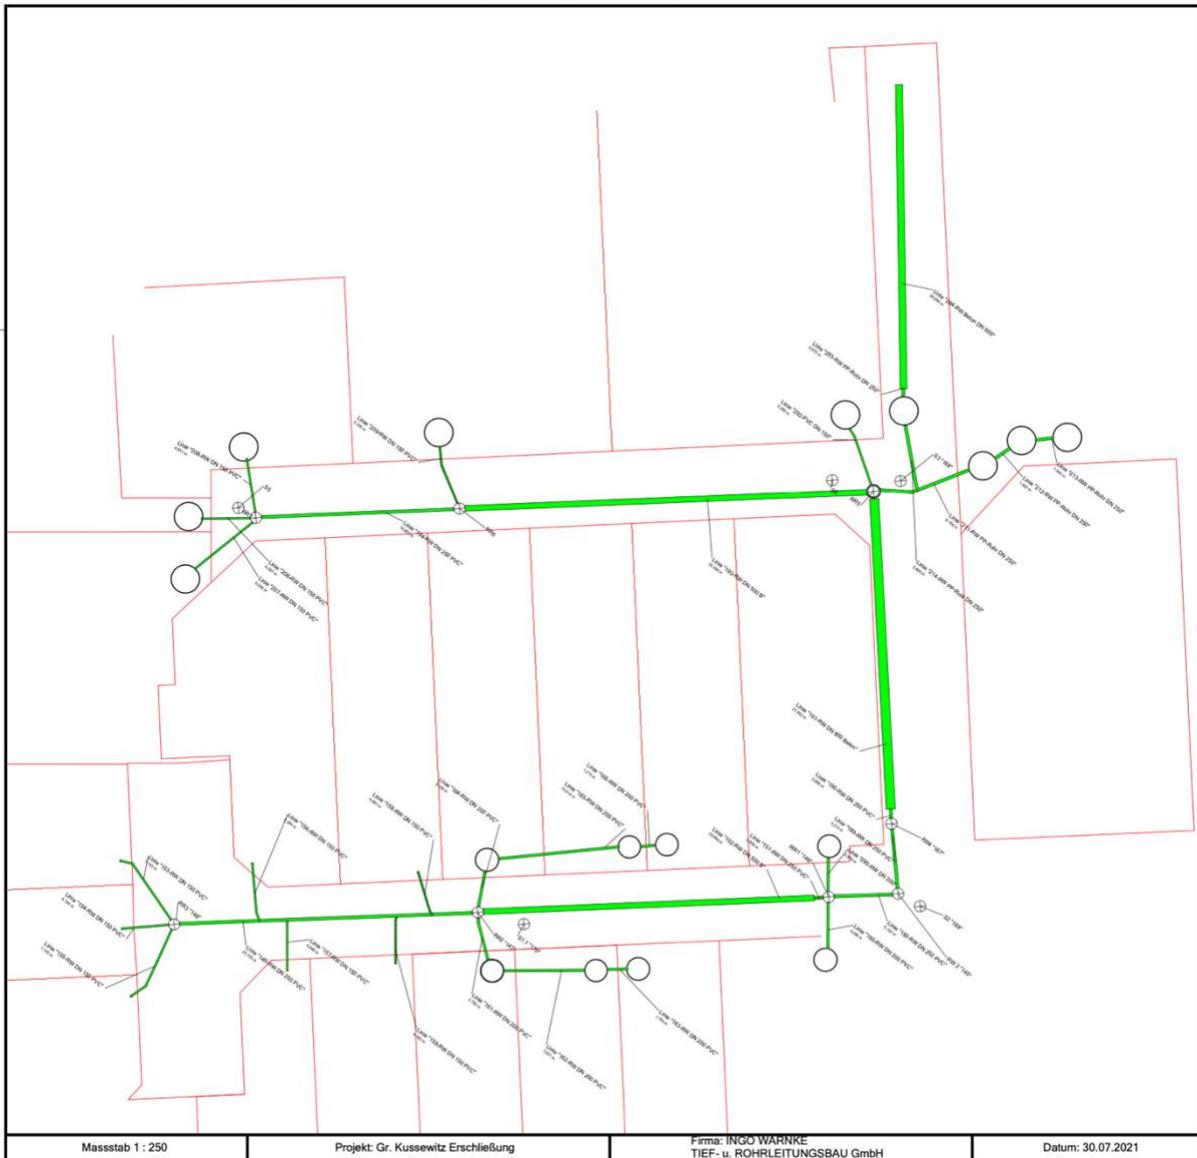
Ausführungsplanung der Regenwasserrückhaltung und -ableitung (Fa. Ingo Warnke, Tief- und Rohrleitungsbau)
